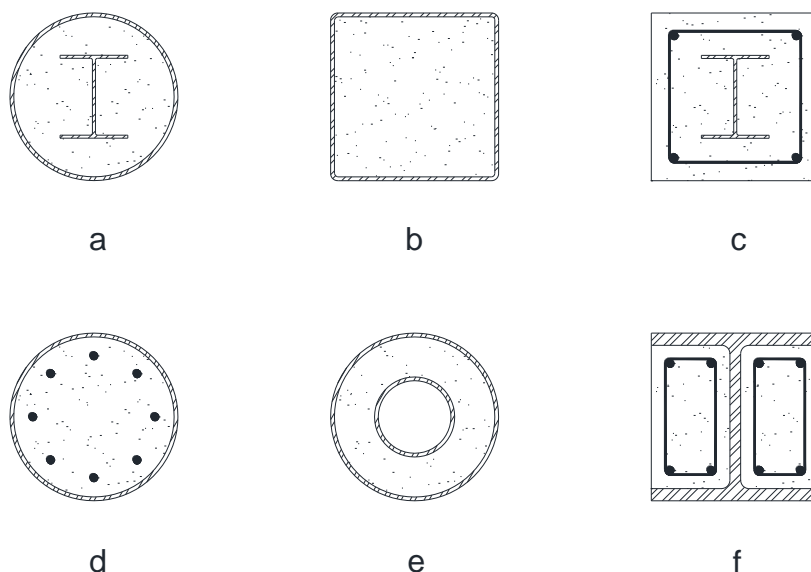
Tipos de secções transversais mais utilizadas
